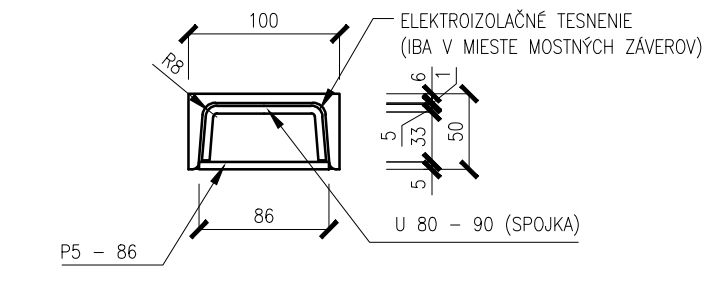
DETAIL ÚCHYTU ZÁBRADLIA M 1:5
